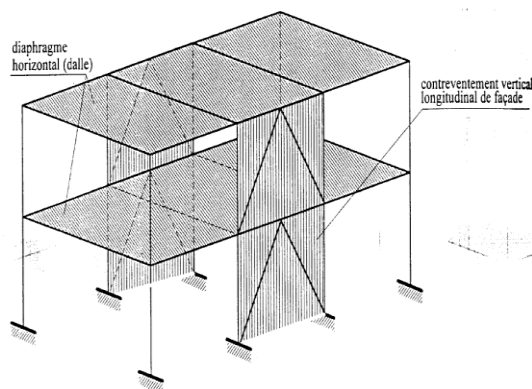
vent longitudinal : deux contreventements verticaux en façades long pan et utilisation du plancher diaphragme comme contreventement horizontal
